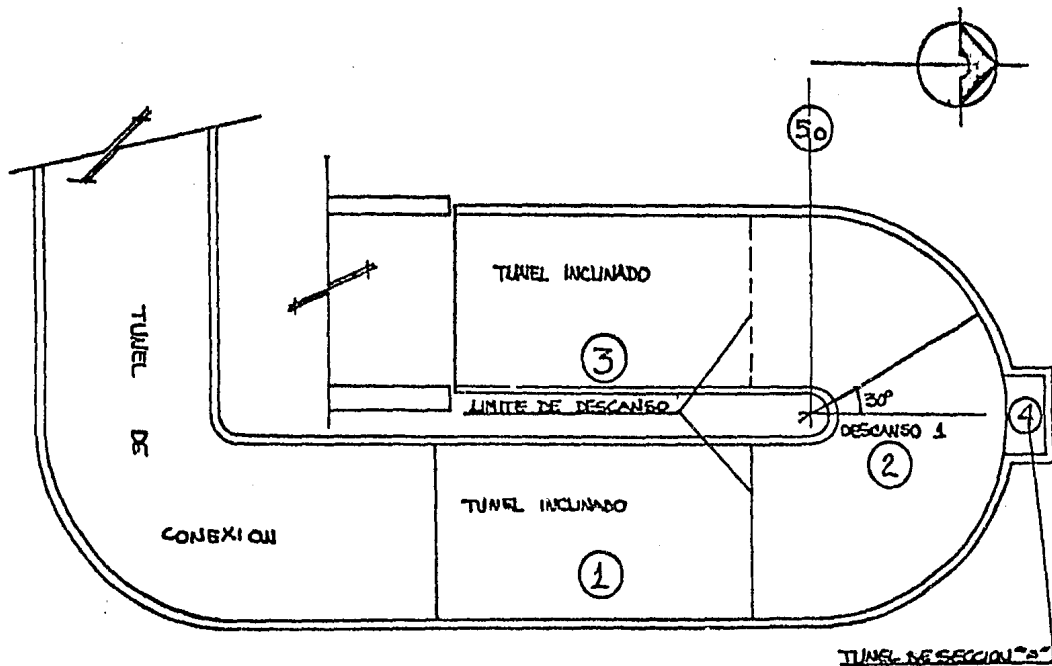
PLANTA DE LOCALIZACION DE ETAPAS
